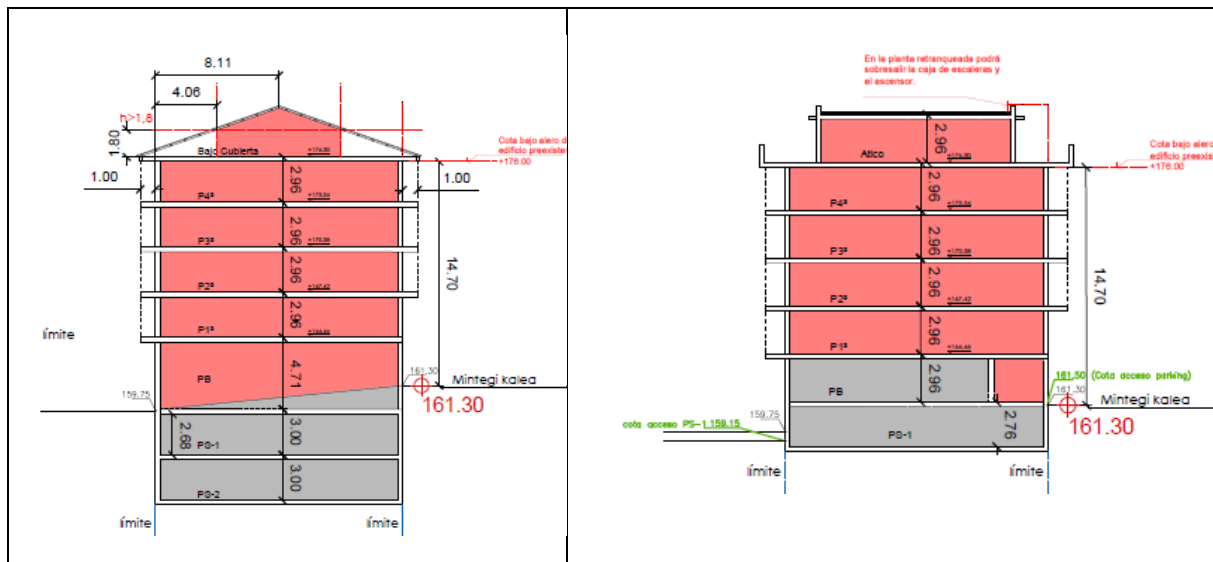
Planos 2.7 y 2.8. Condiciones de edificación de la parcela: PGOU (izquierda) y Plan Especial (derecha).
